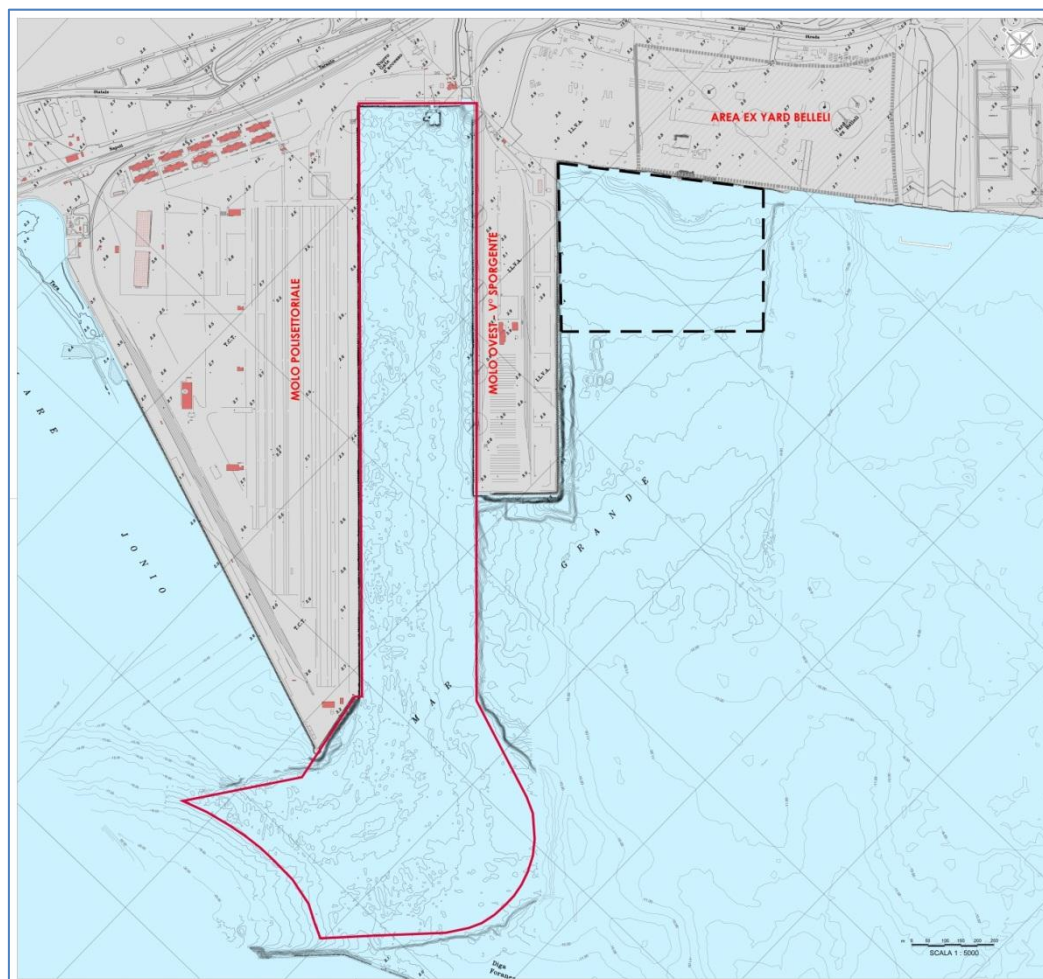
Stralcio Planimetrico con Ubicazione Aree di intervento
